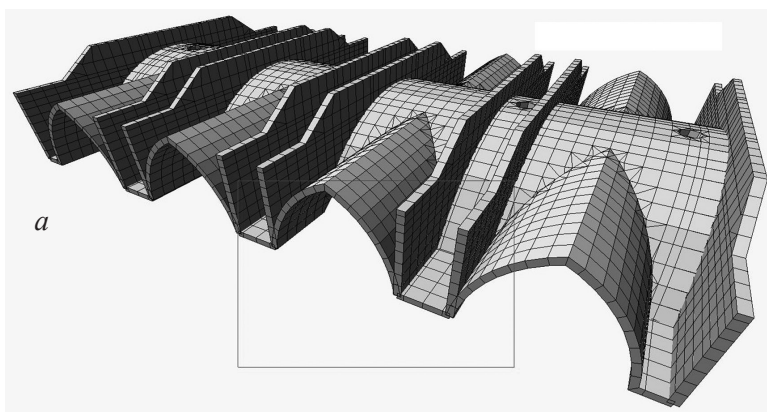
Схемы монолитных железобетонных сводов Церкви Святого Духа:
